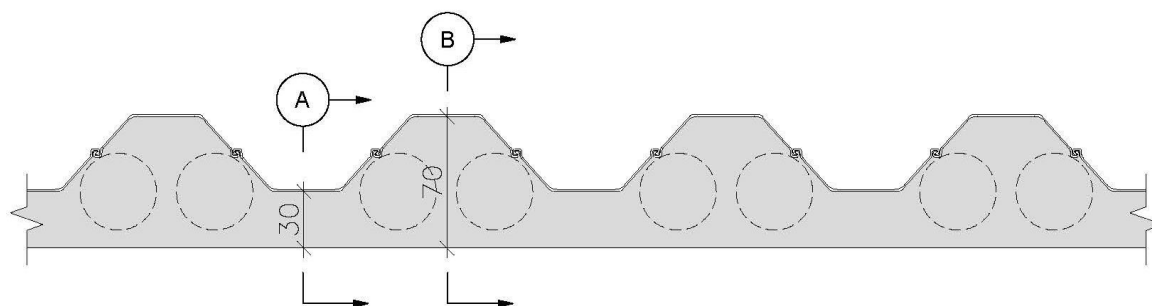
Croqui da planta da longarina do tipo II (medidas em centímetros).
